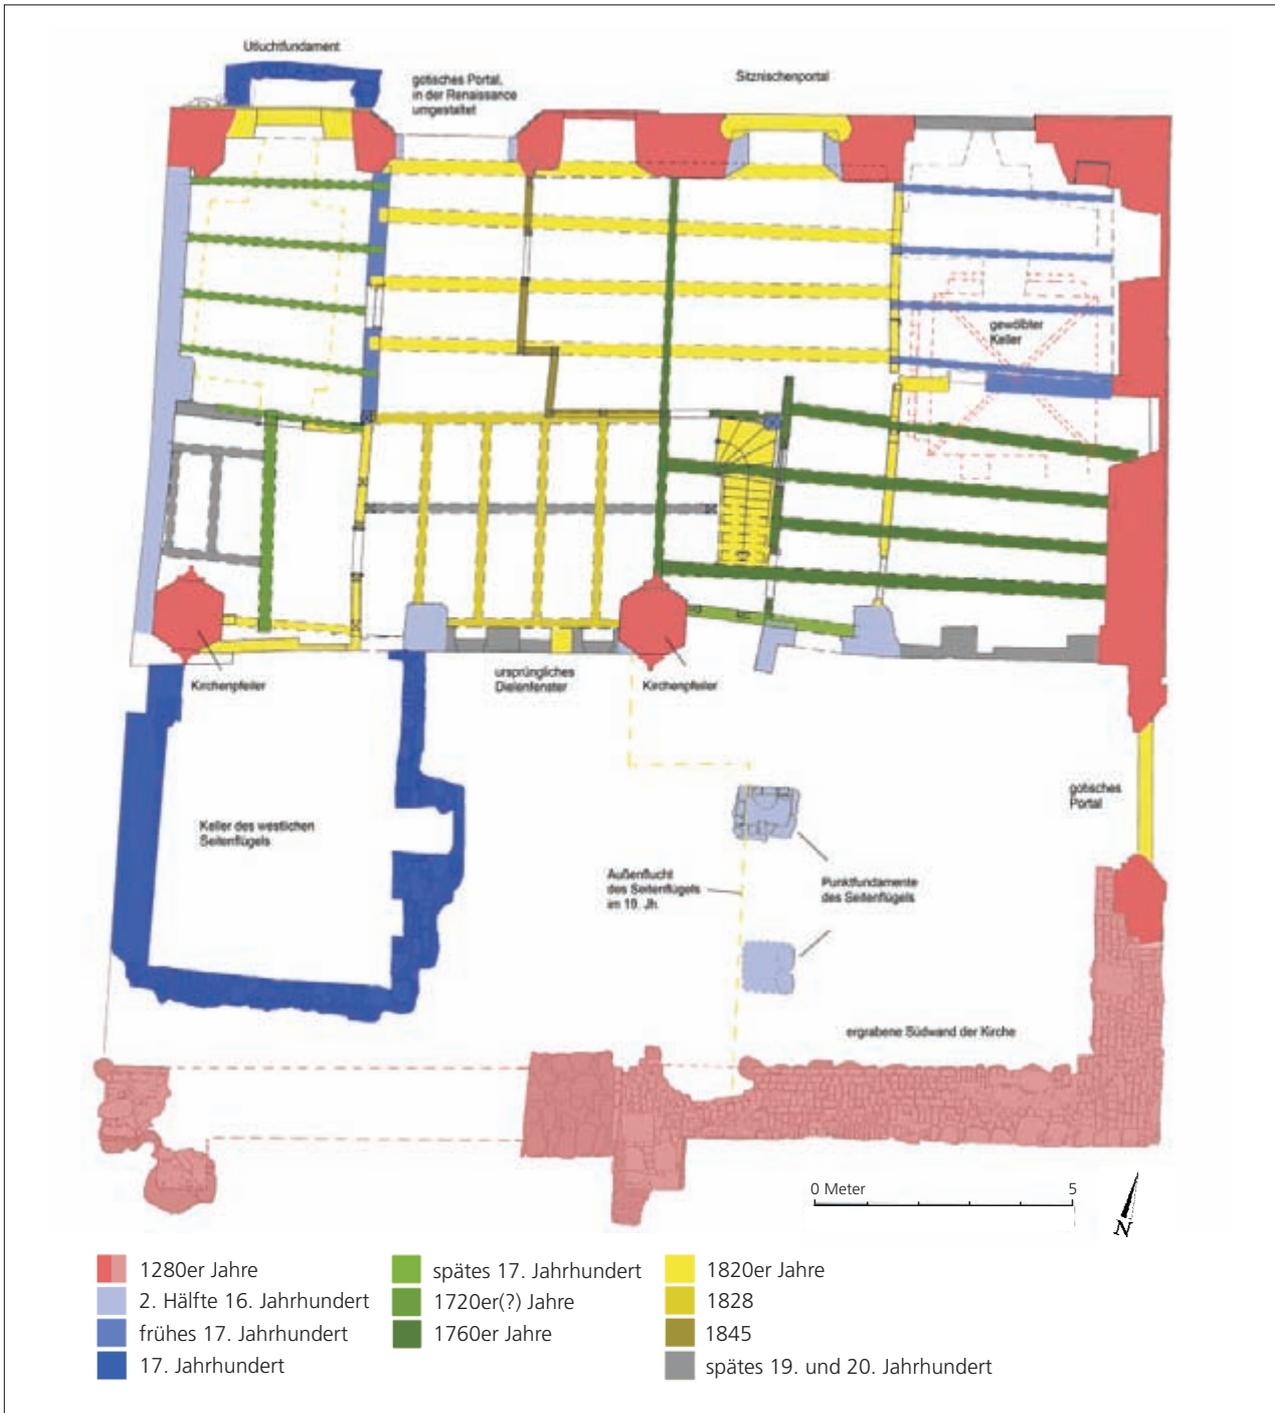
Grundrissplan mit Baualterskartierung für das Erdgeschoss des Vordergebäudes Lange Straße 51 sowie für die im südlichen Hofbereich freigelegten Mauerwerksbefunde
